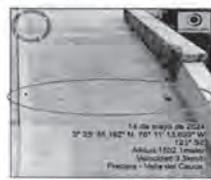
Grieta transversal 52 cm de longitud; nivel de severidad baja.
